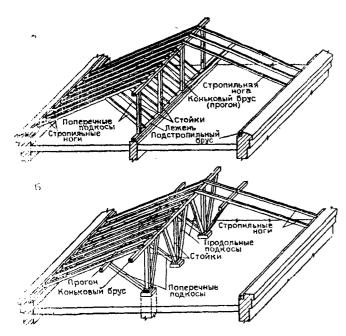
Схема наслонных стропил с опираннем стоек на внутреннюю продольную стену; δ — то же, на столбы
